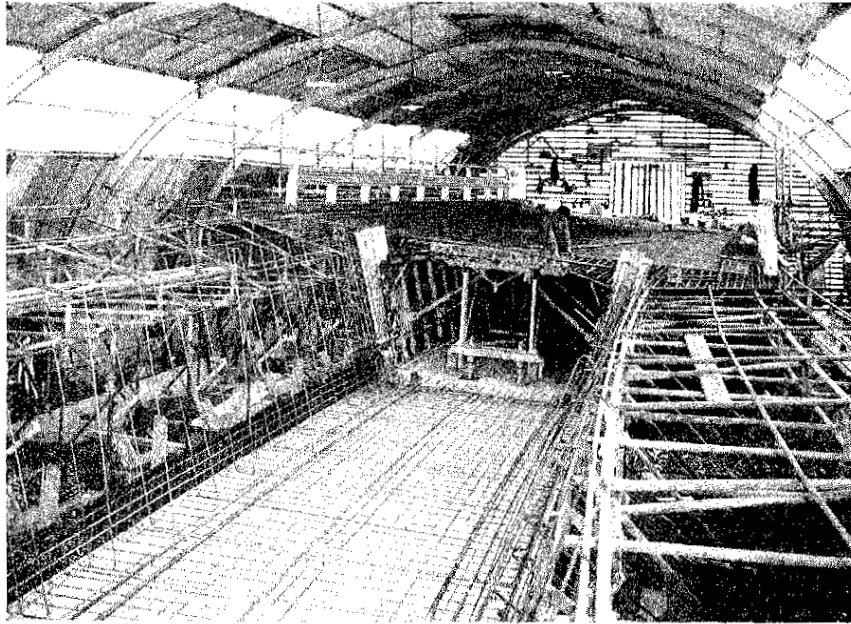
Vista del cobertizo-taller. En primer término, el encofrado preparado para el hormigonado de la losa inferior de la viga cajón.
